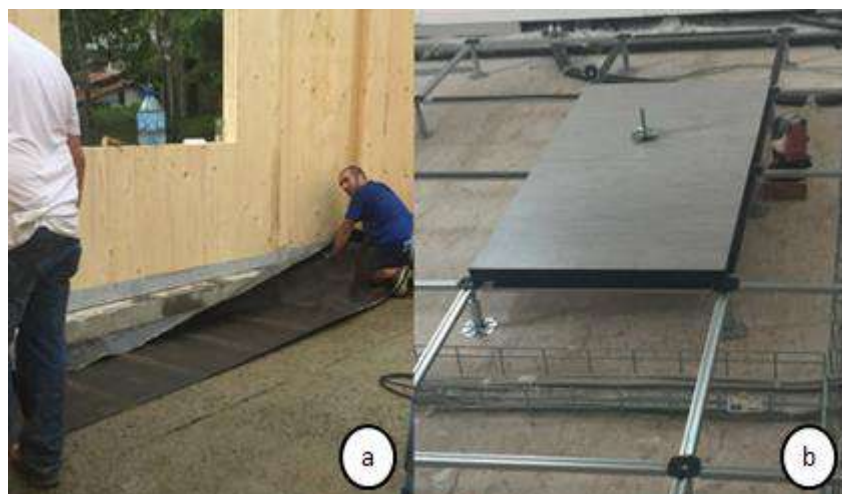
Colocação da manta asfáltica (a). Instalação dos pisos elevados.
